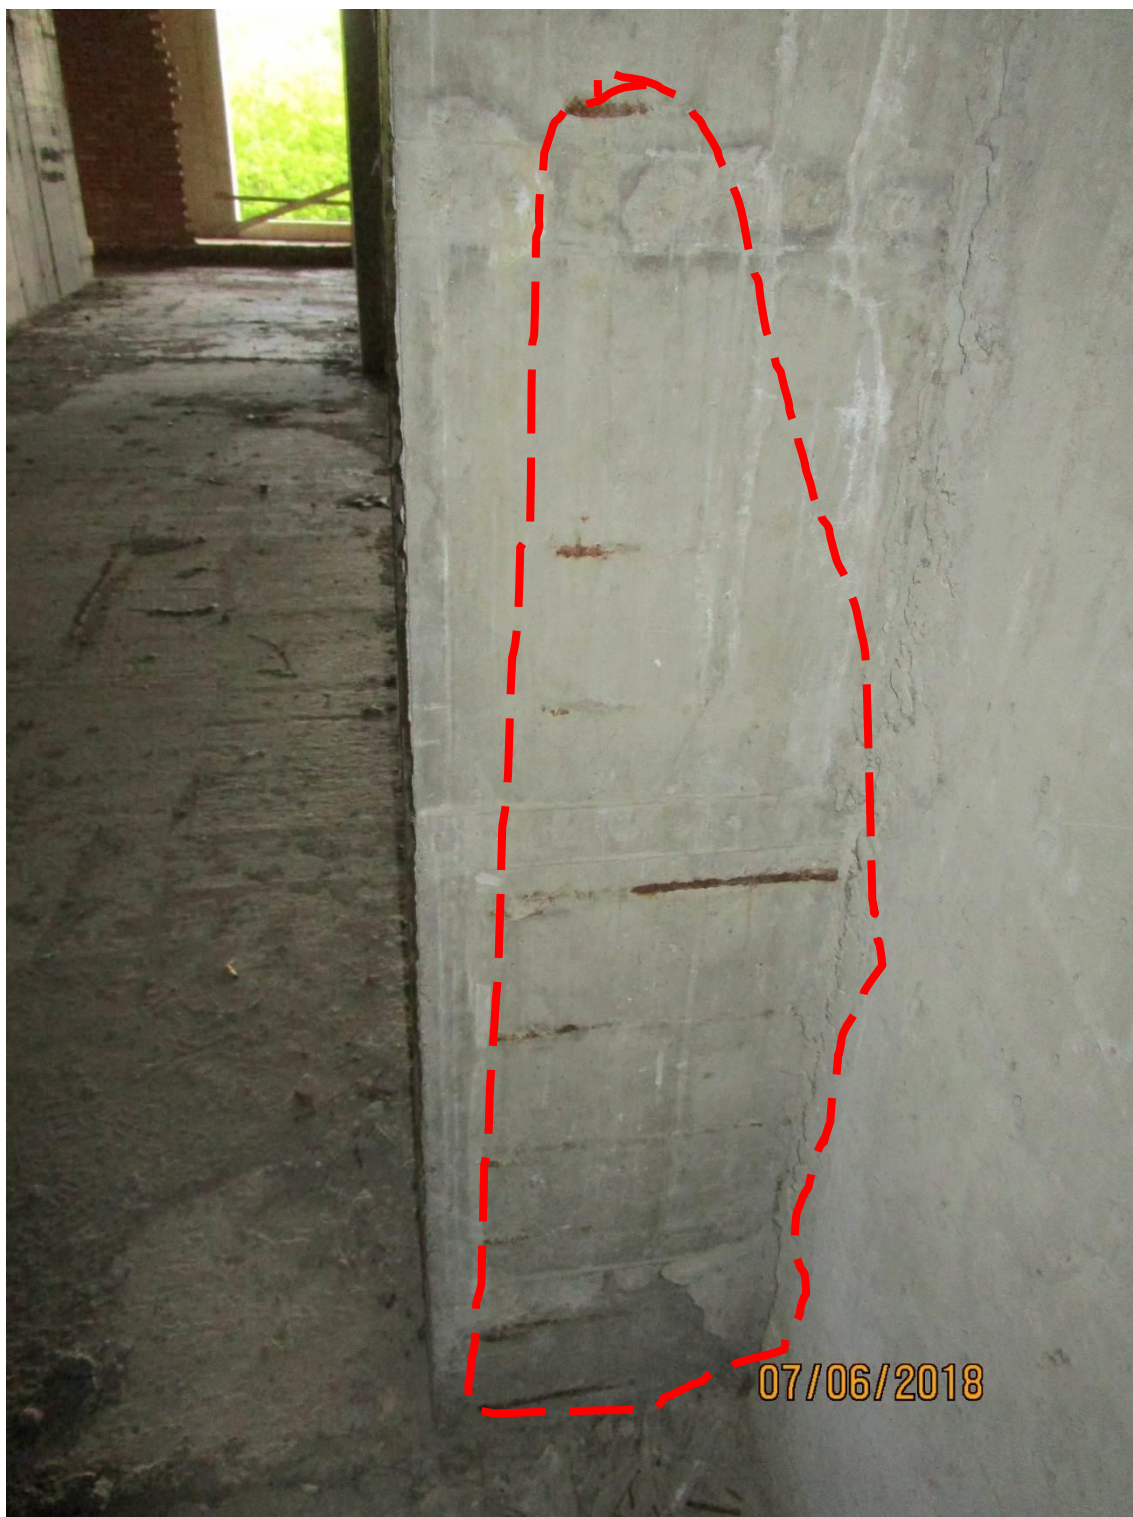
Колонна в осях 19/М с отм. 0,000 из-за смещения каркаса оголена рабочая арматура.
